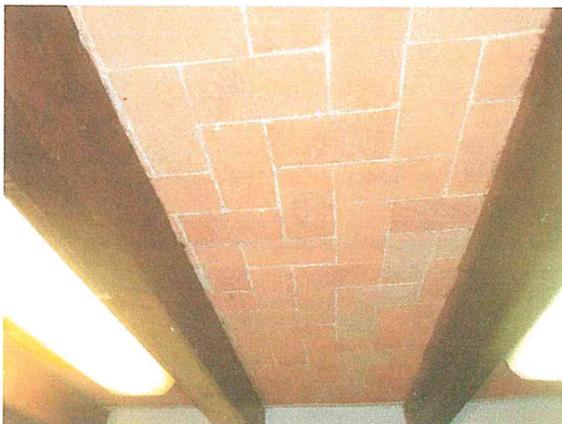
Entrepiso enladrillado y vigas de madera de la segunda construcción, en buen estado estructural.
